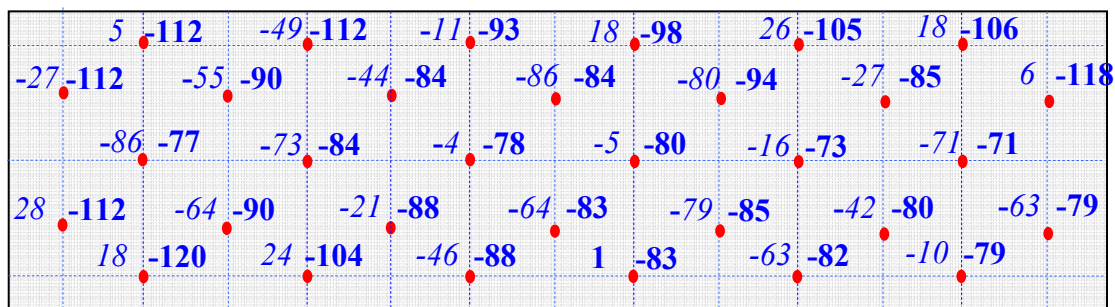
Potenciais de corrosão na face da viga V10.
